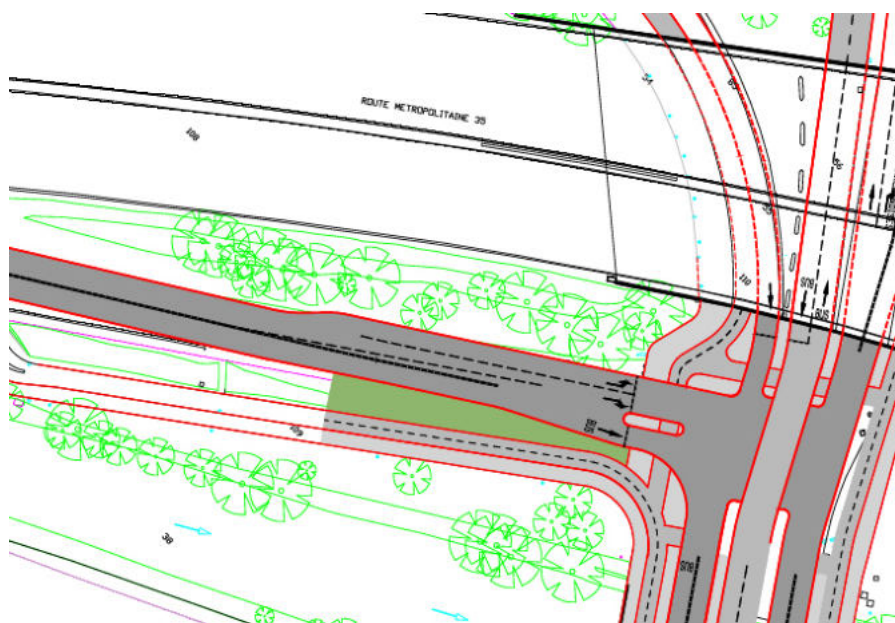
VUE EN PLAN SORTIE M35 « LES HALLES »
